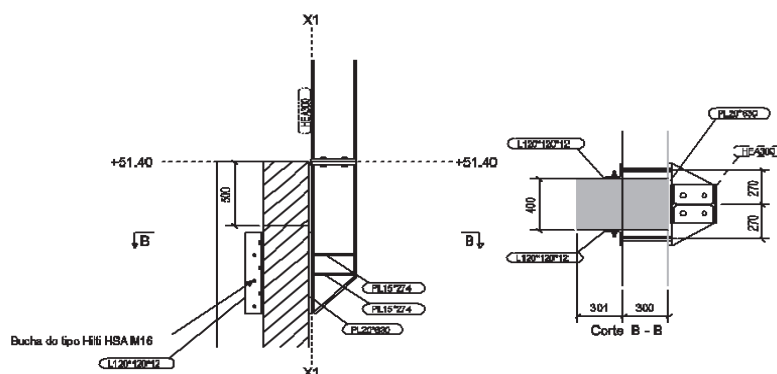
Proposta de alteração da fixação dos pilares no edifício existente.
